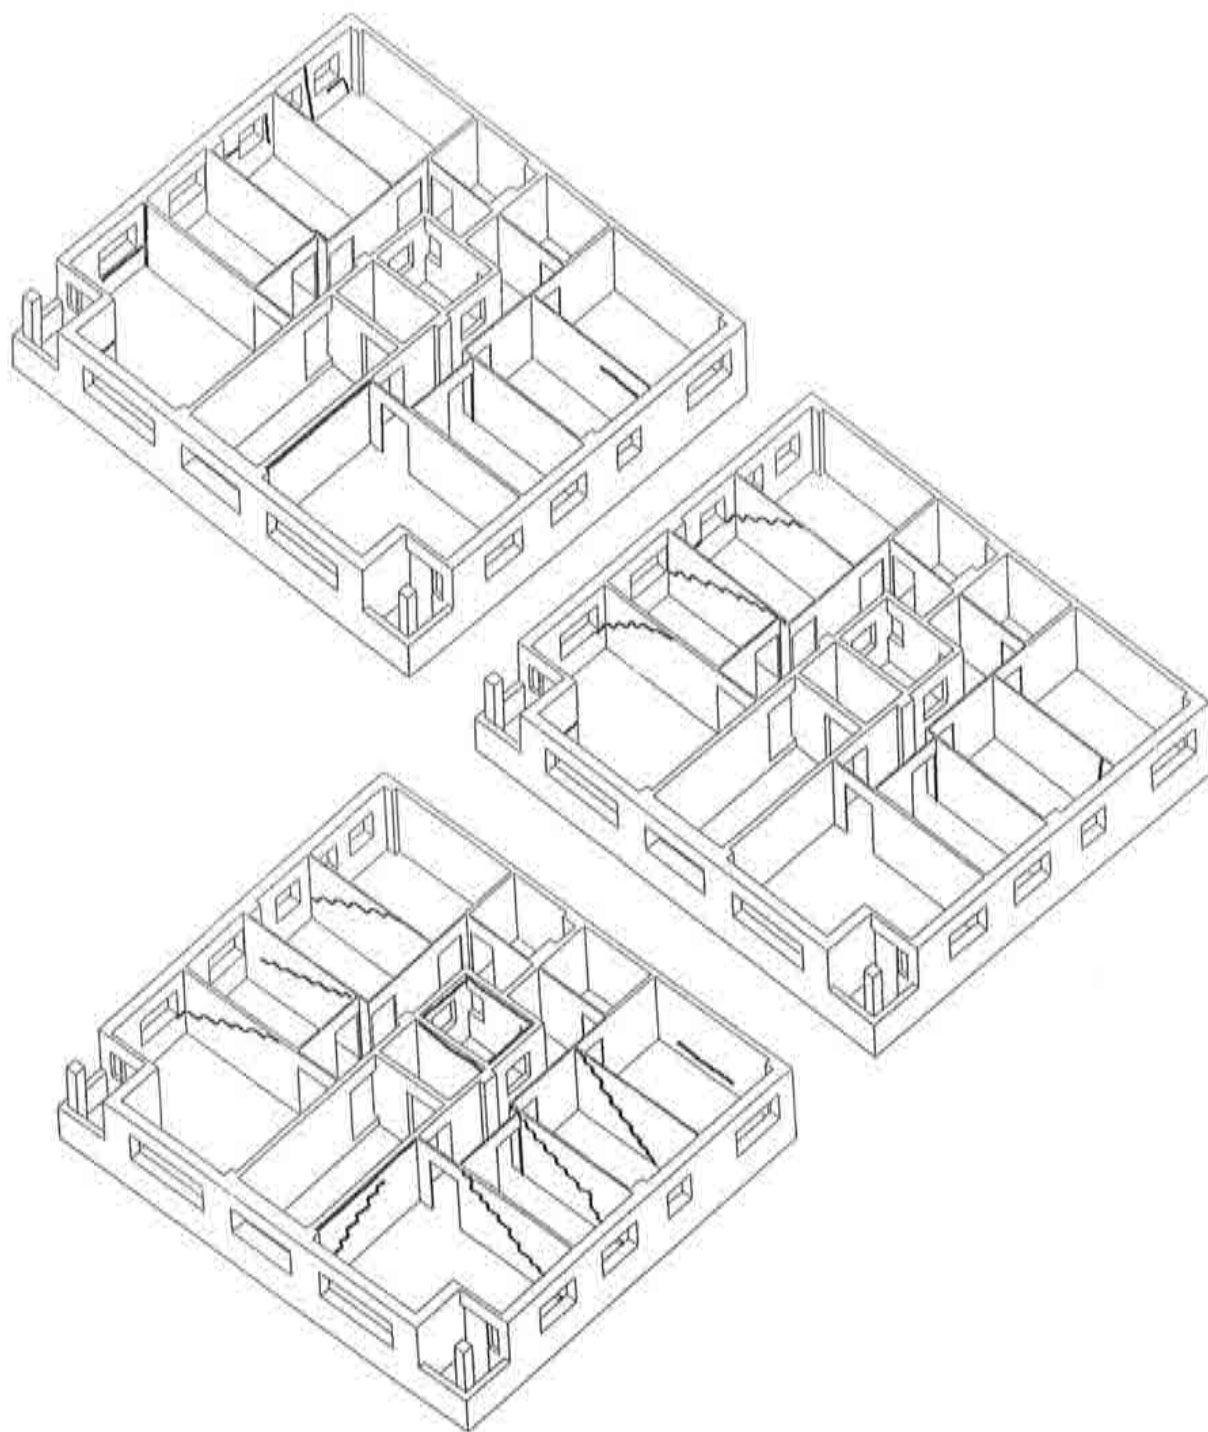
Grietas observadas en las plantas primera, segunda y tercera.
